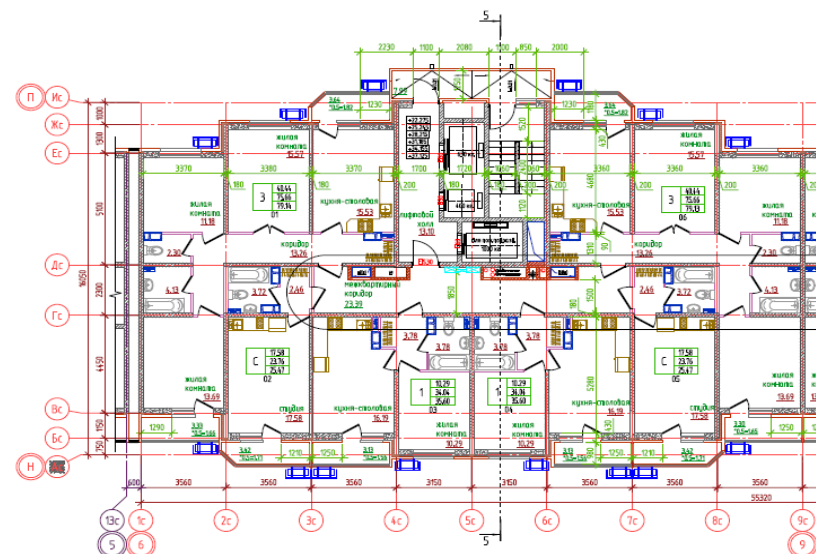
Типовой план 8-13 этажа БС-6 ЖК URAL
